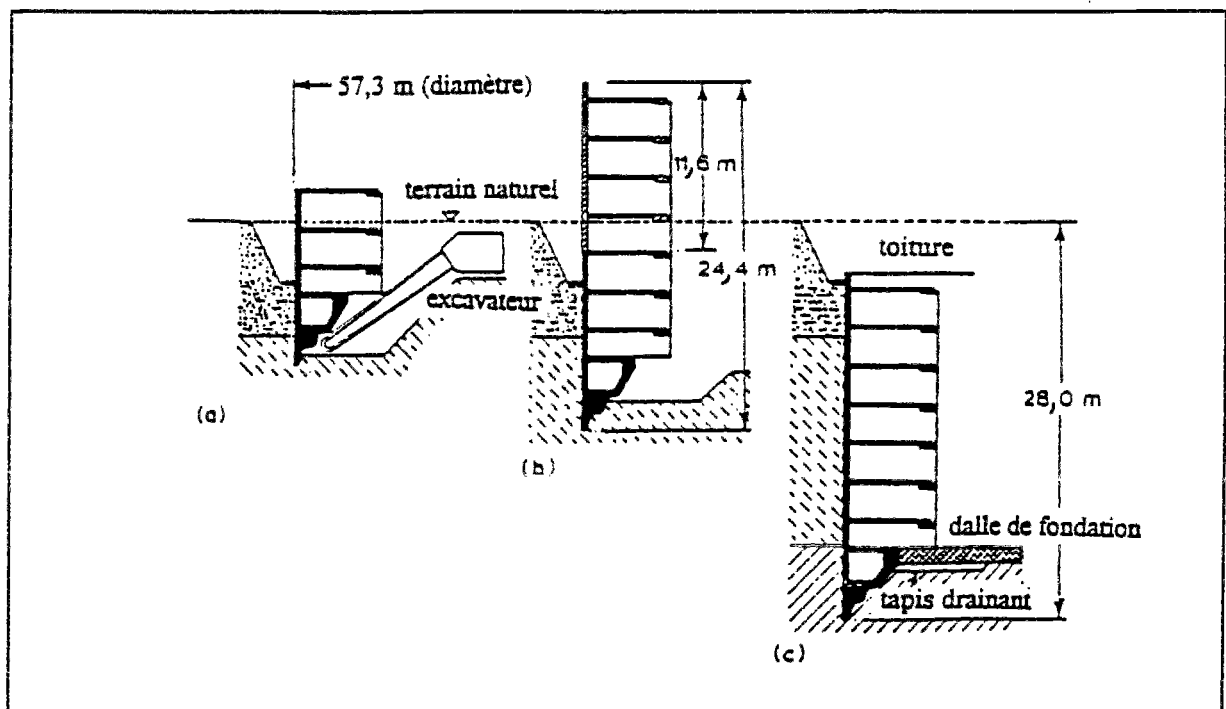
Etapes de fonçage d'un caisson sous son propre poids (a) trousse coupante et trois étages de soubassement en place (b) bétonnage, excavation et fonçage continuent simultanément (c) dalle de fondation placée (Henry, 1986).
